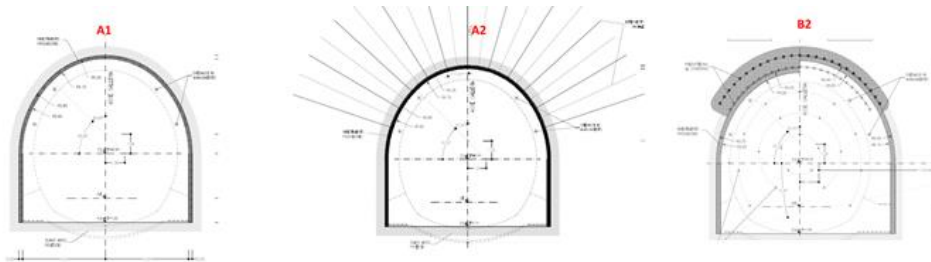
Zona imbocco lato Bari, galleria di linea a doppia canna e singolo binario, sezioni tipo A1, A2 e B2 (progetto definitivo).
